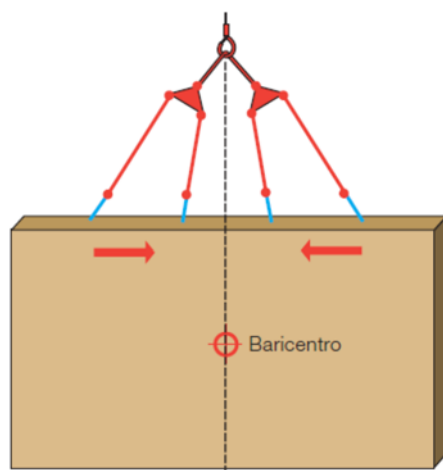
Sollevamento di elementi pesanti con due tiranti a 2 bracci (dispositivi di compensazione)
